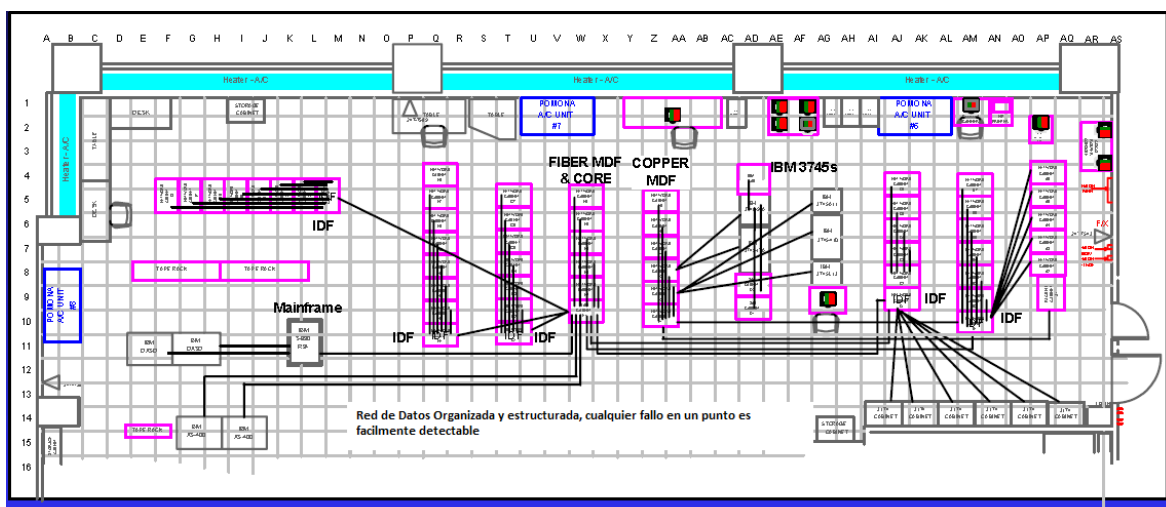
Vista de un Centro de Datos con Cableado Estructurado
